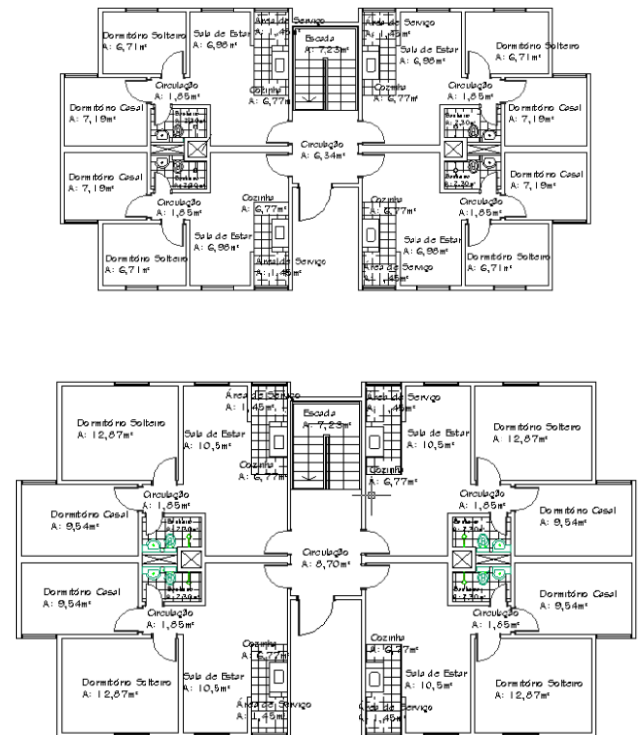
Projeto original e projeto modificado pelo aumento de área de um pavimento
